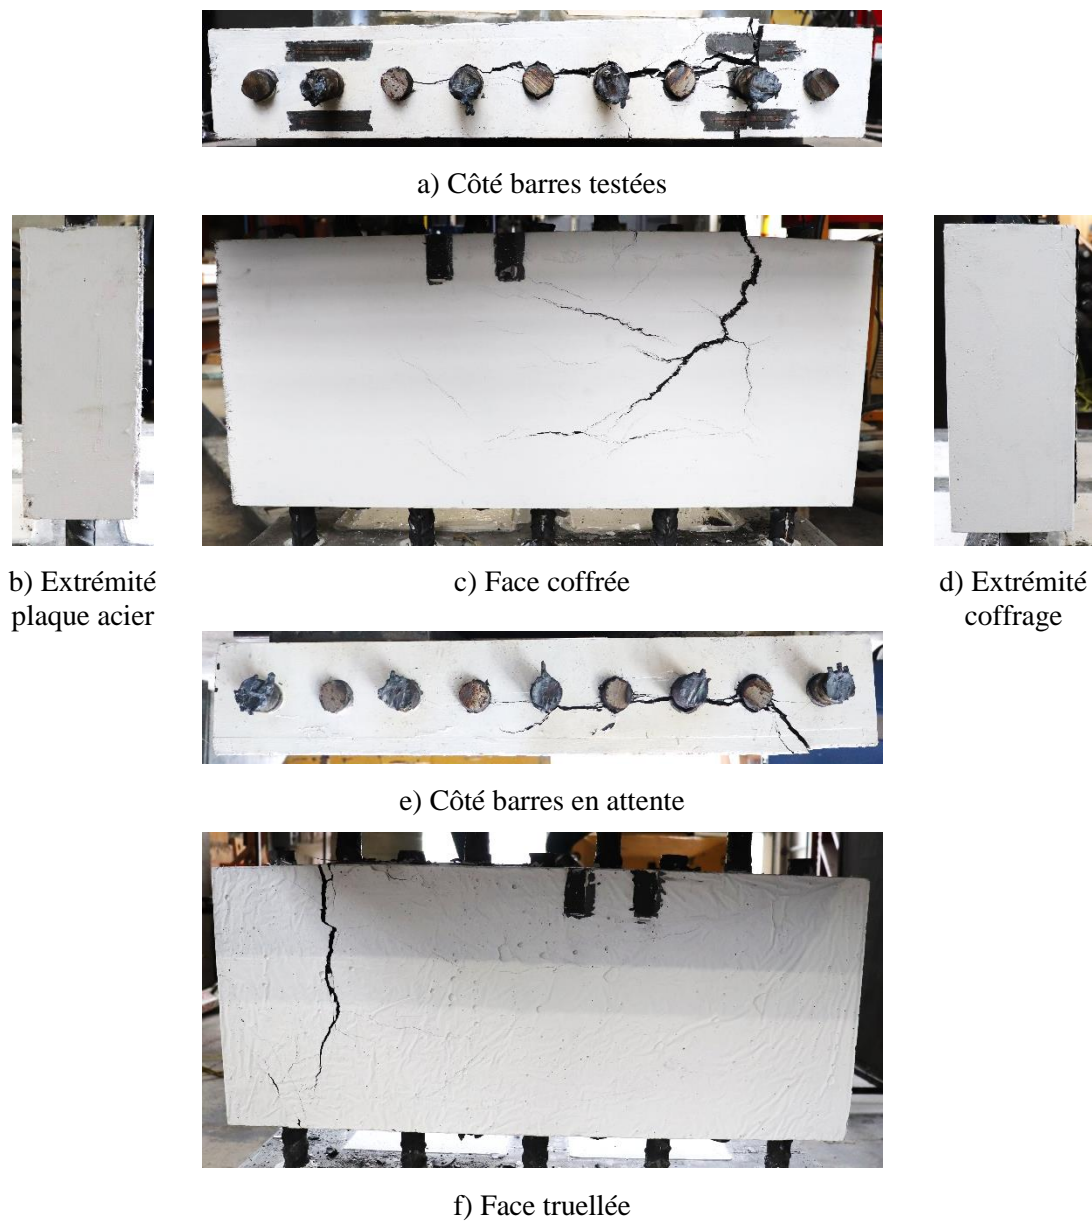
Fissuration observée en laboratoire - Spécimen NCS-1
